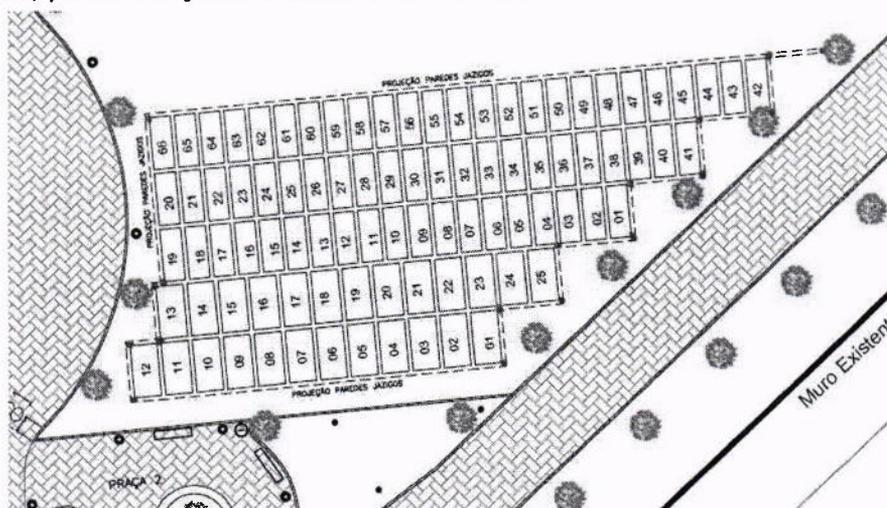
= Figura 10: Planta baixa executiva – jazigo comum.
